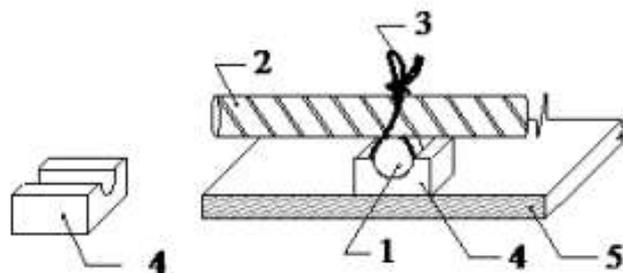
Установка фиксаторов арматуры: 1-продольной стержень; 2 – поперечный стержень; 3 – вязальная проволока; 4 – фиксатор; 5 – палуба
